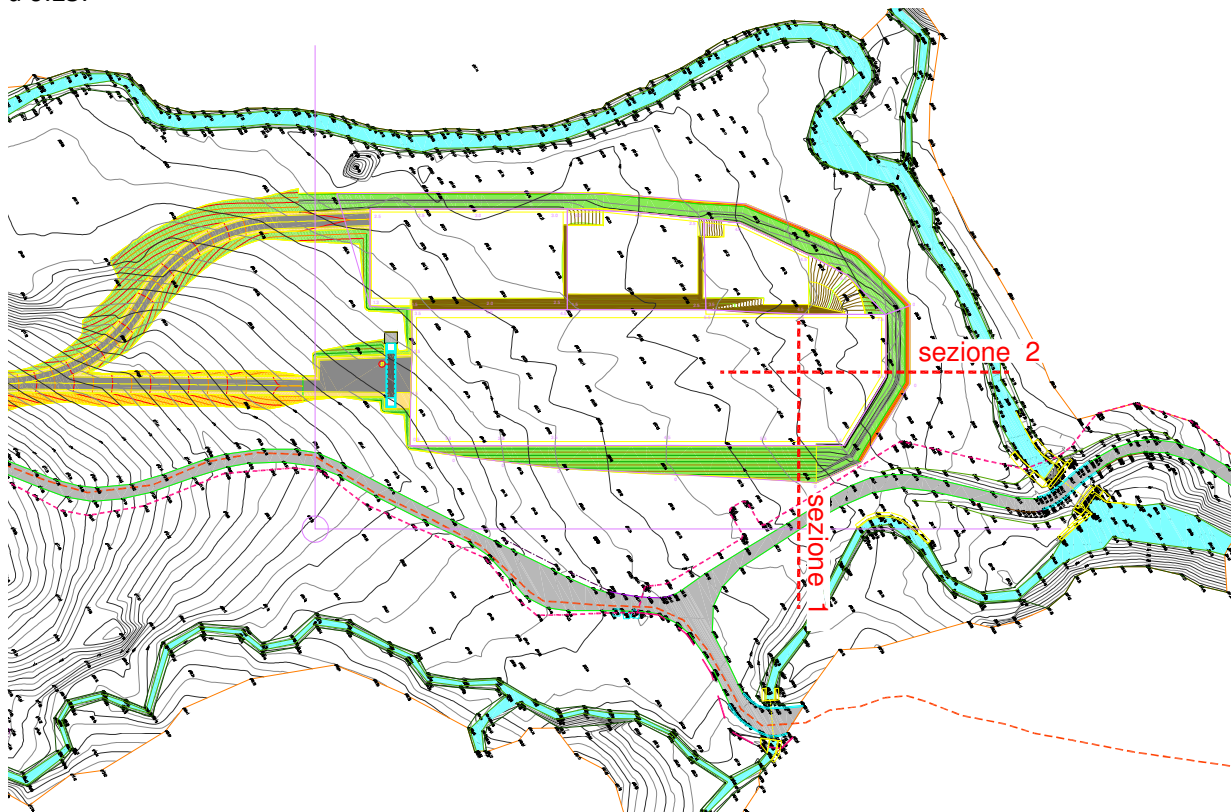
Traccia delle sezioni di verifica della stabilità del rilevato.
